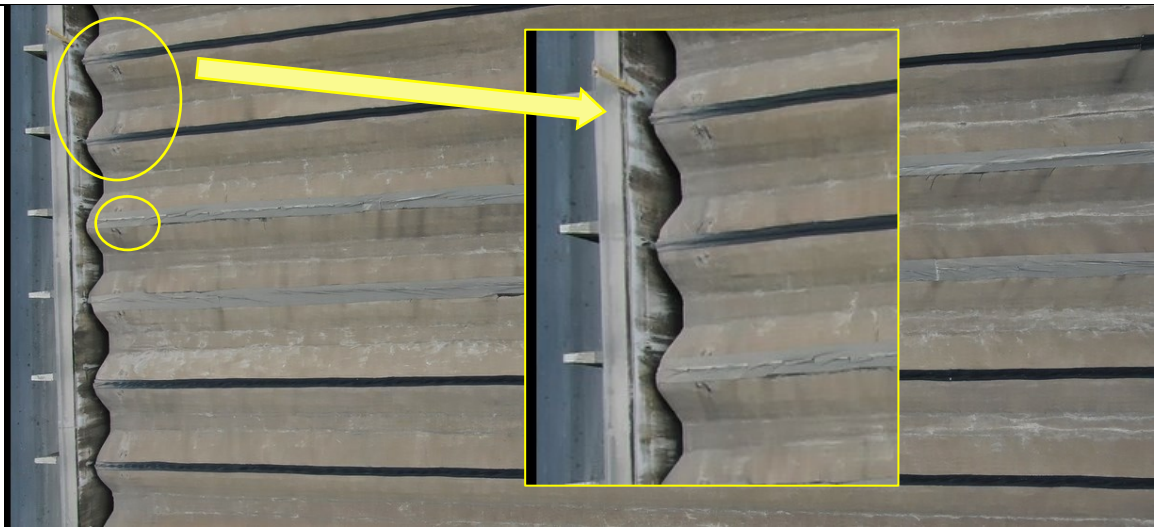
Deslocamento do concreto e armadura exposta na área superficial da telha;
